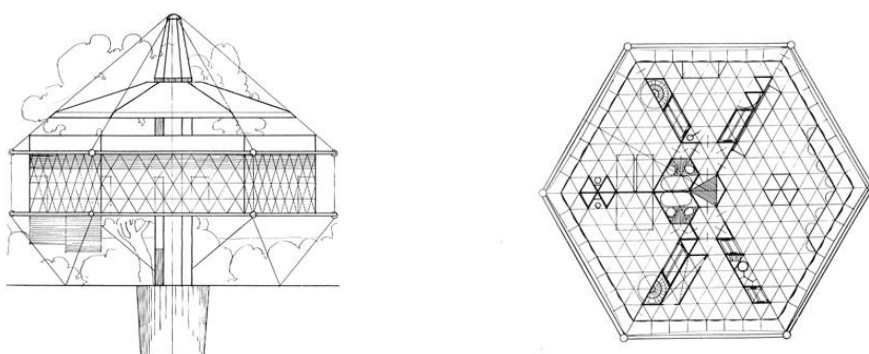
Esq.: Corte da «Dymaxion House Project»; Dir.: Planta – s/ esc. (Buckminster Fuller Institute, 2006).
